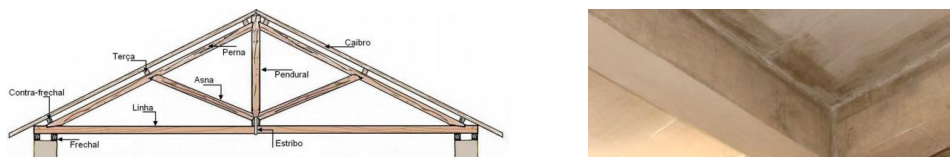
Esquema tipo da estrutura em tesoura simples com asnas substituída por laje vigada (Fonte: dennysfs.blogspot.com)
